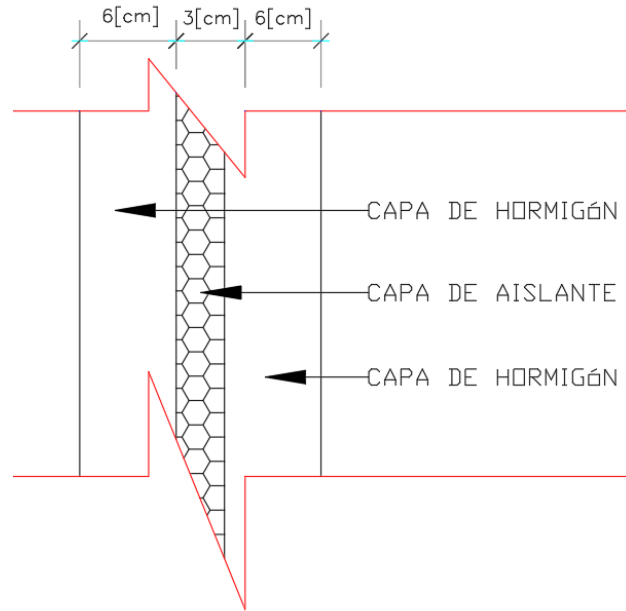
Sección transversal del muro sándwich, unidades en centímetro.
